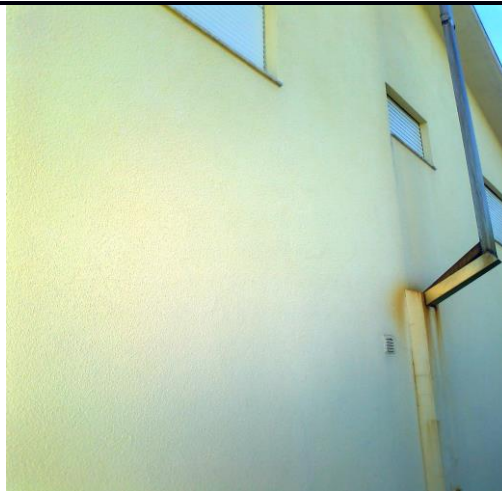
Sujidade, marcas de escorrência de água e fissuras na fachada O.
